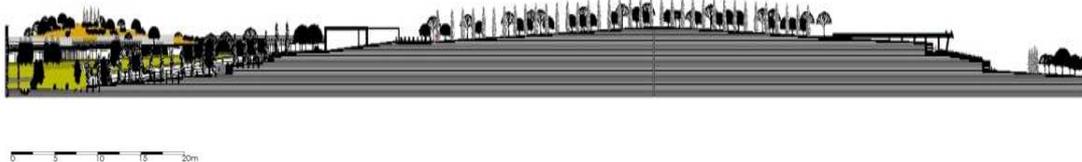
Corte longitudinal da totalidade da área de intervenção – adequação da proposta à estrutural original do relevo.
